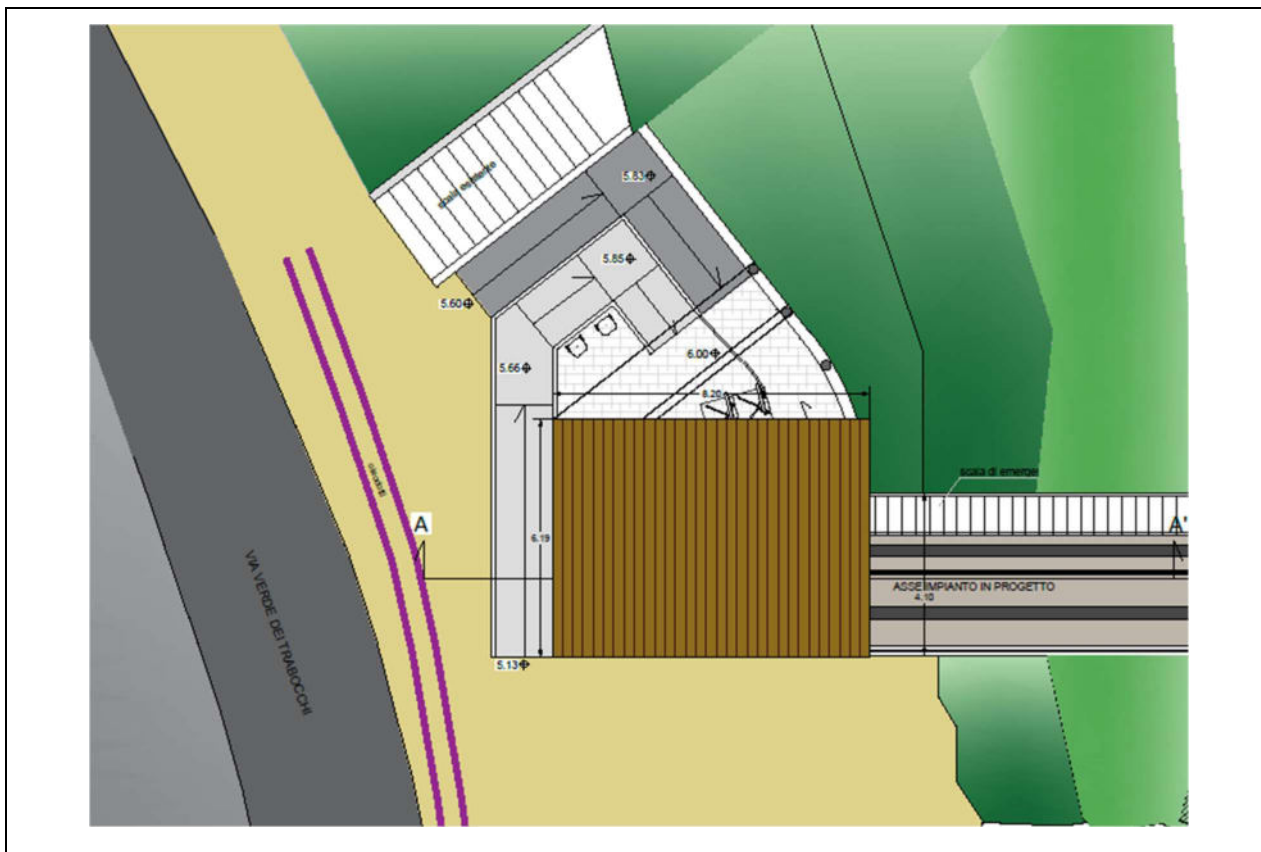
Piante Stazione di Valle (Elaborato EG22)
